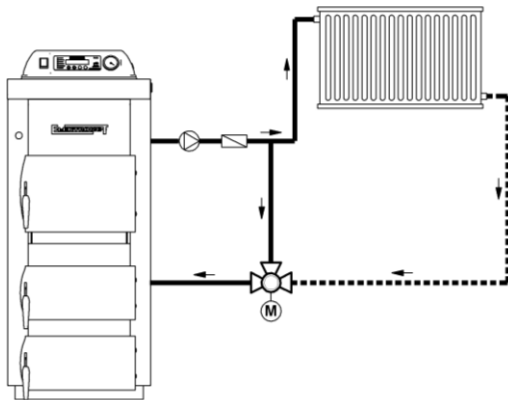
Przykład montażu zaworu mieszającego czterodrogowego
